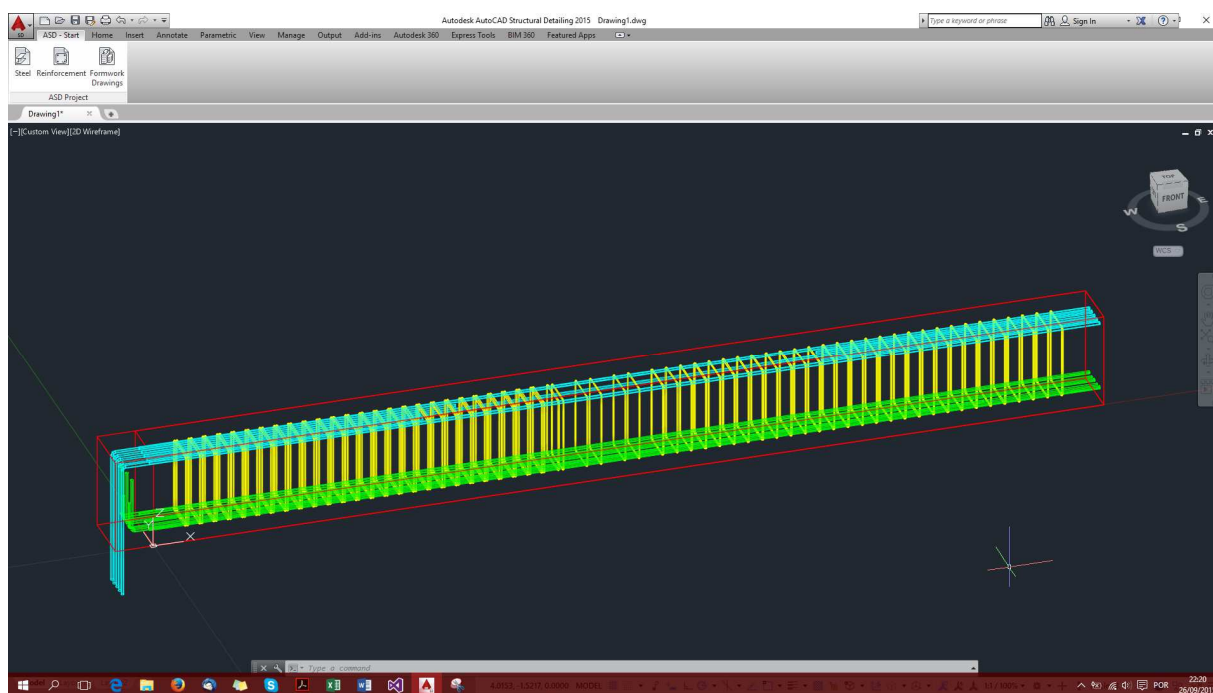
Pormenorização de uma viga recorrendo ao addin (vista 3D).
